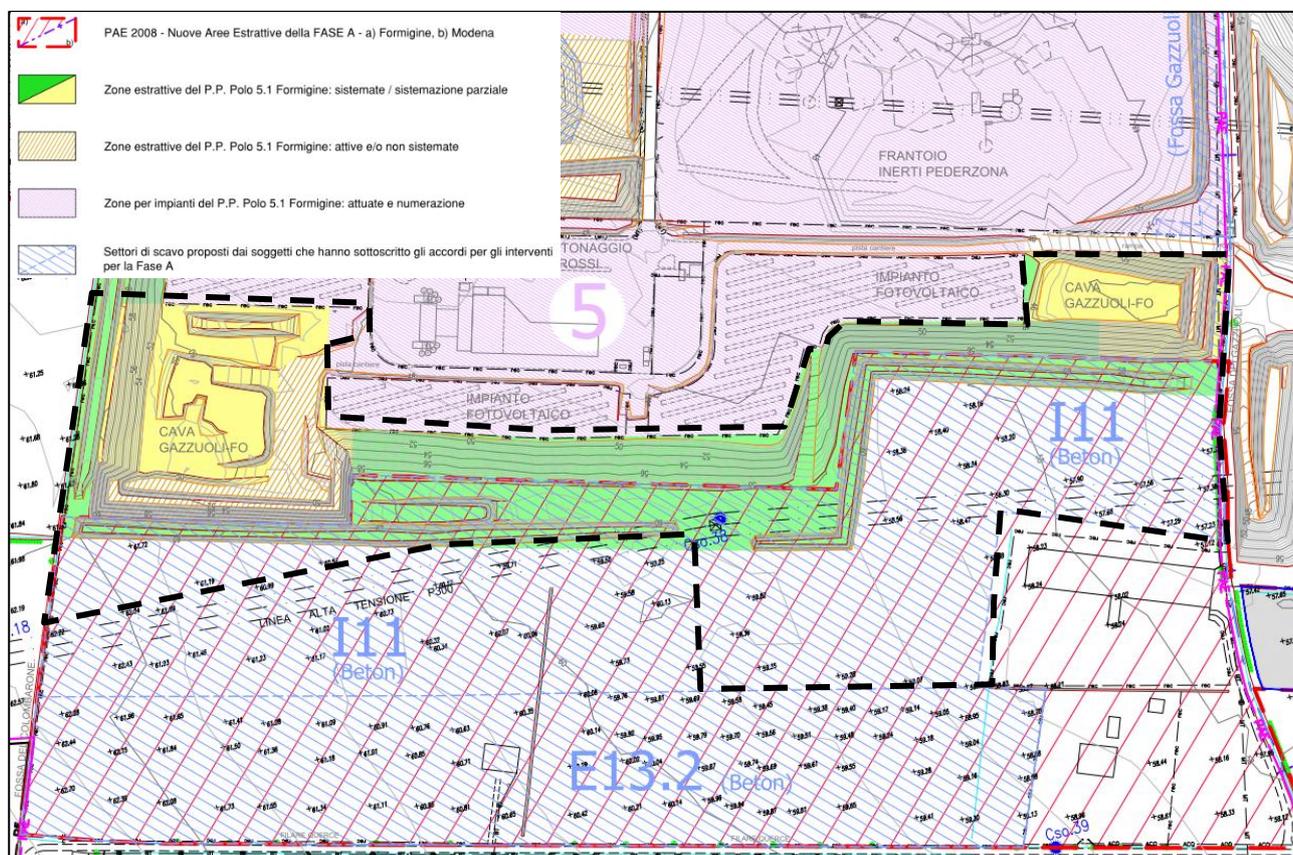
Estratto della tavola 2.2.a del PC "Planimetria dello stato di fatto"
